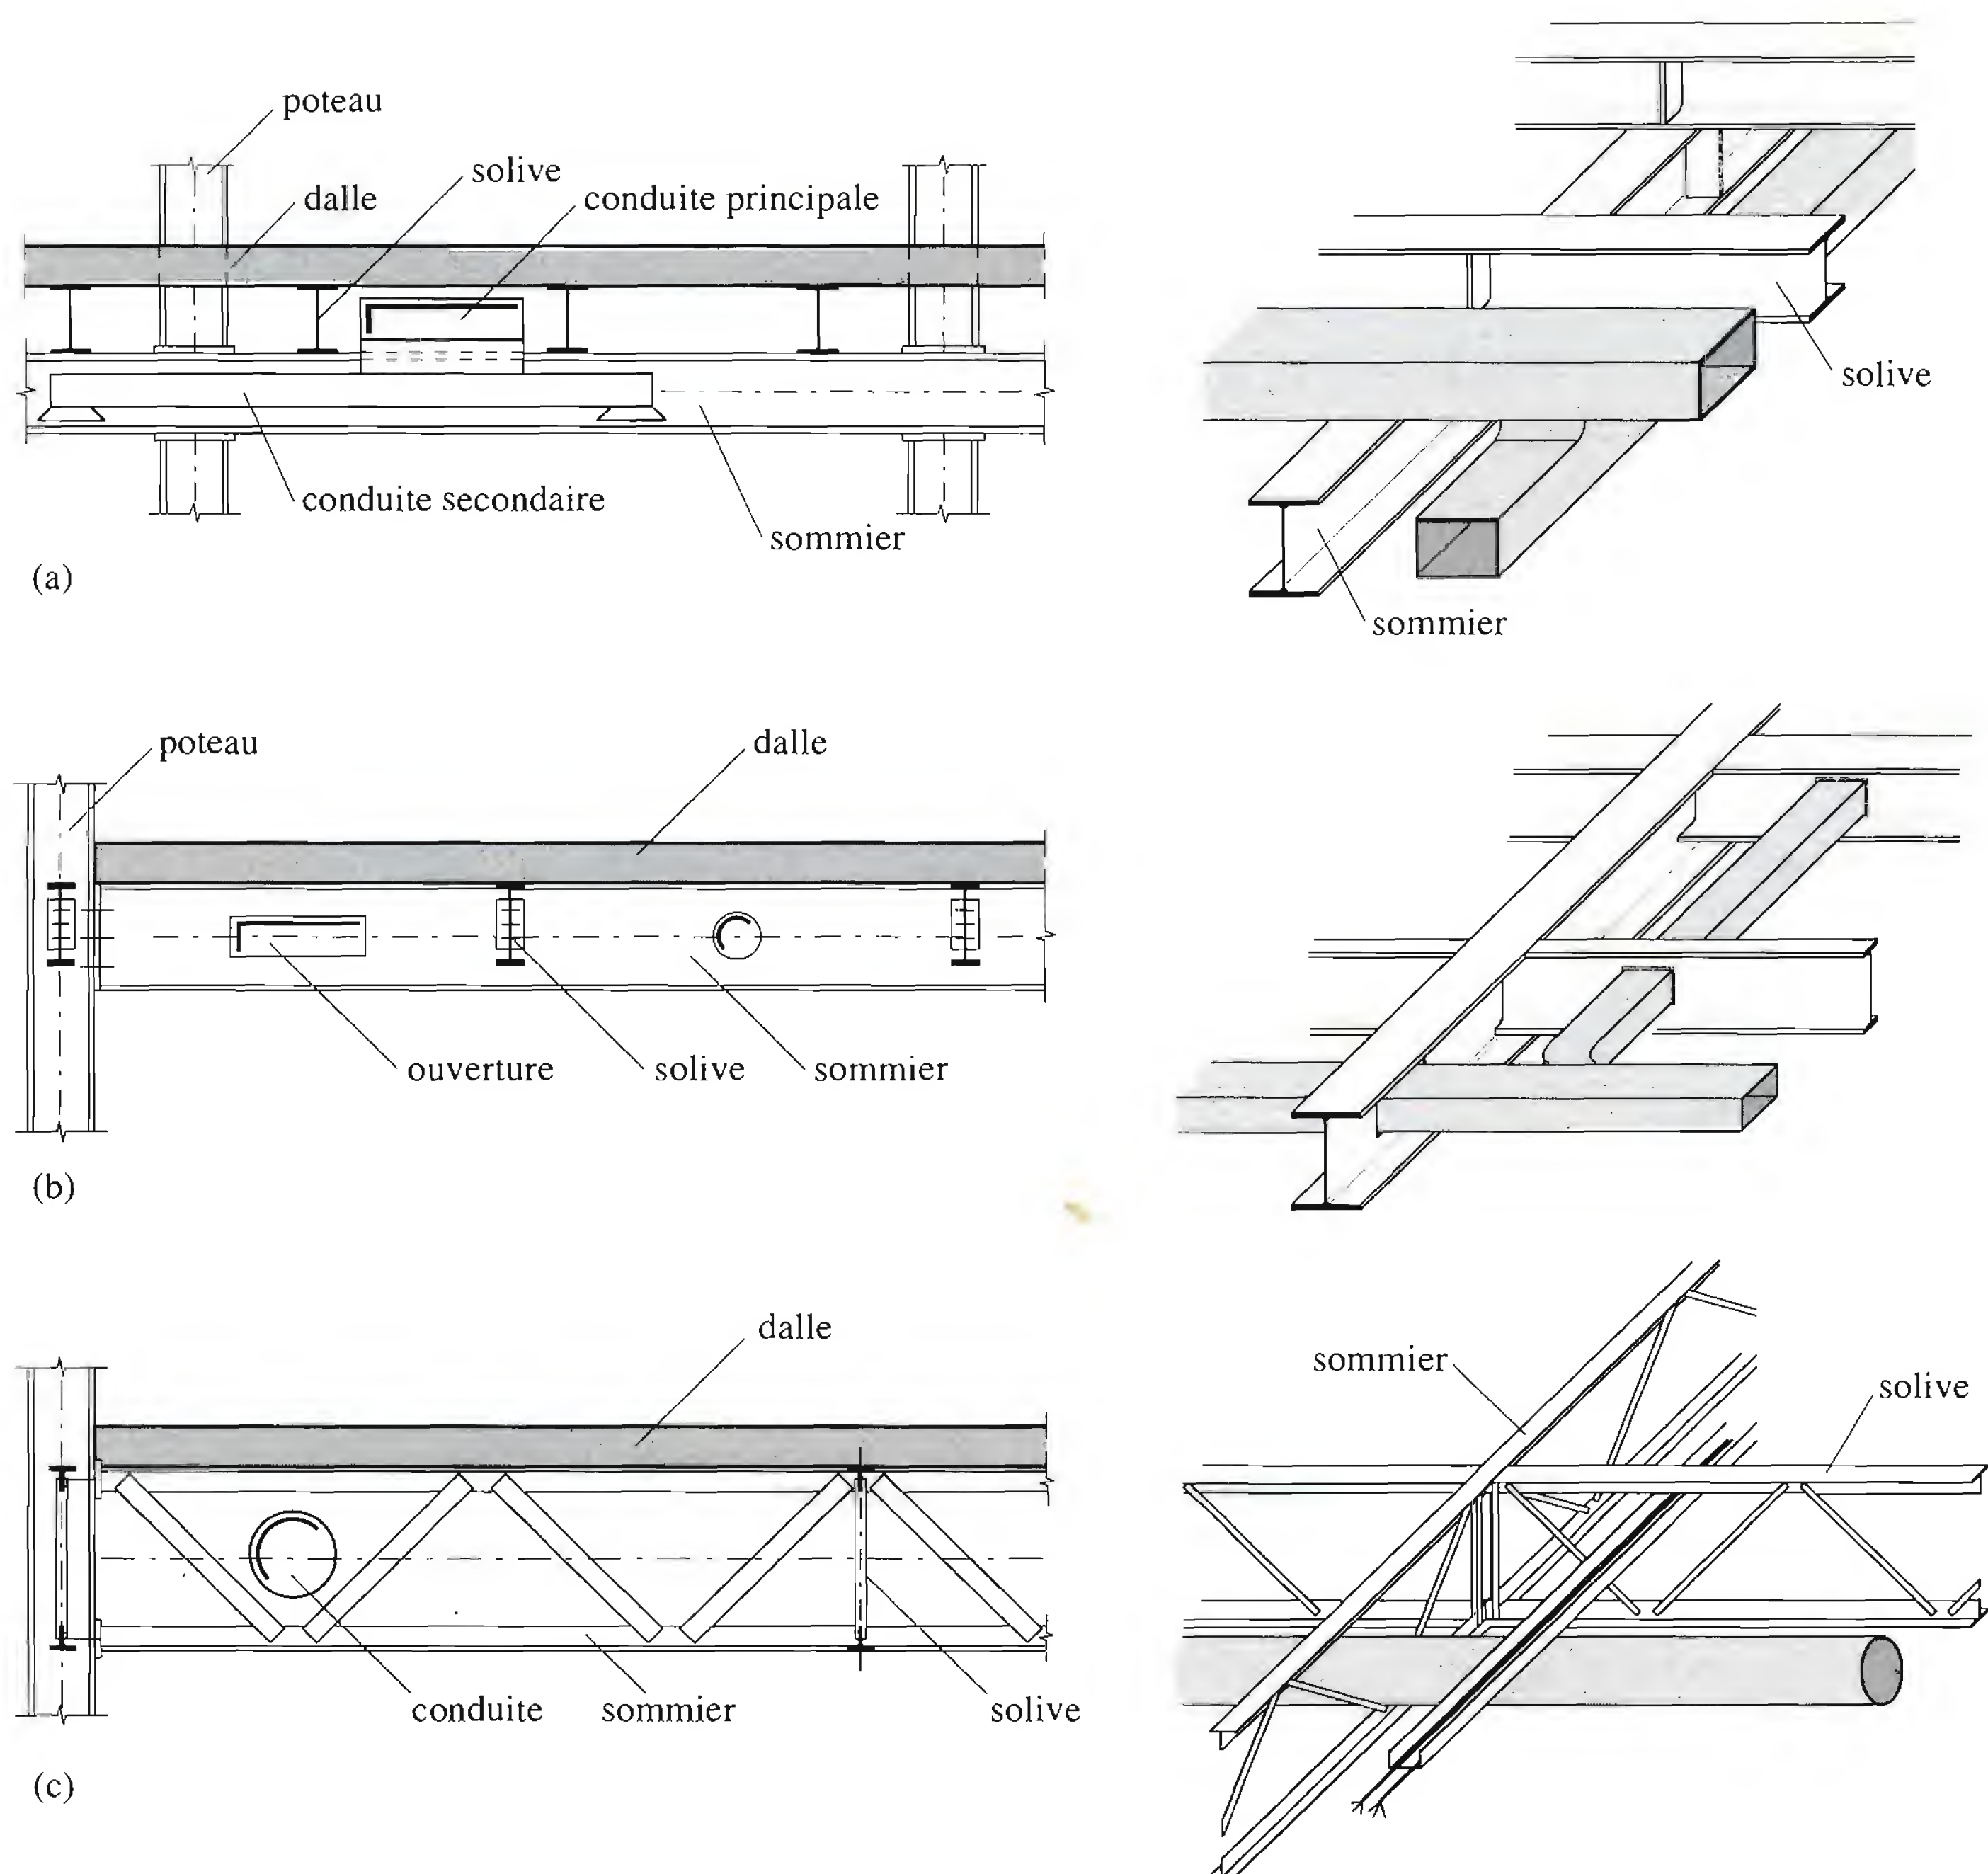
Exemples de planchers à deux niveaux de poutres (tiré de [4.1]).
